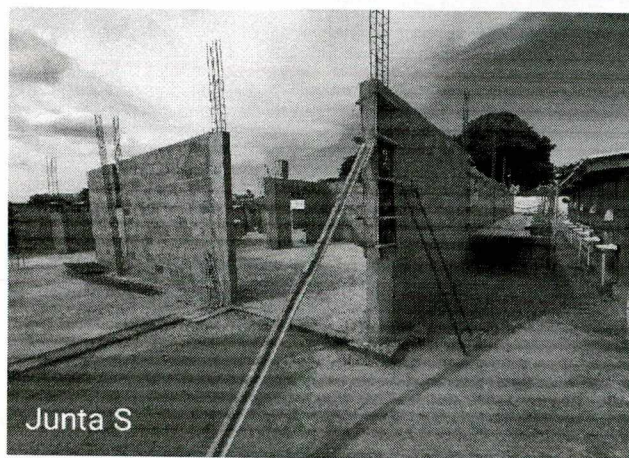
a 59: Execução de alvenaria de segunda etapa; concretagem de pilares; concretagem da laje e execução de alvenaria da platibanda.
